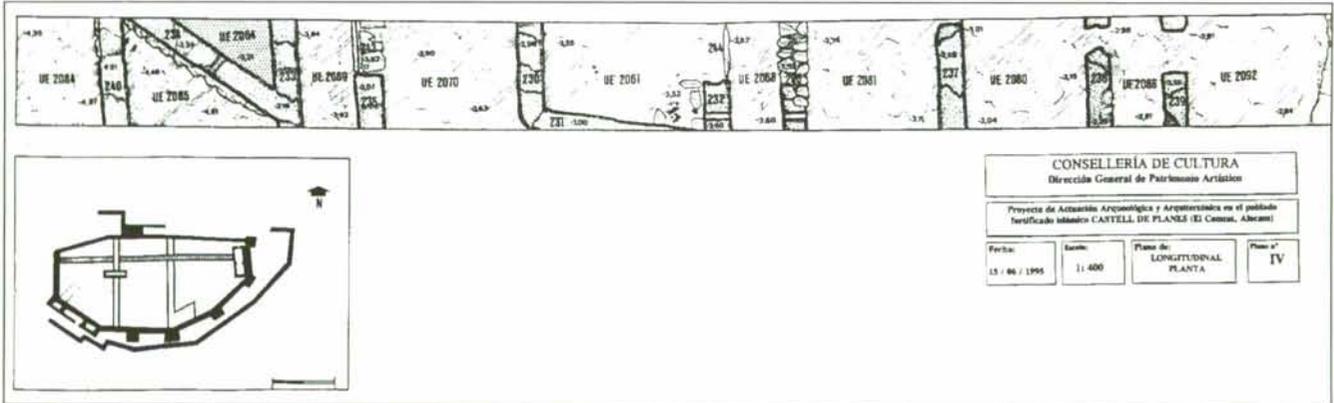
Planta de las estructuras del poblado exhumadas en el sector Este.
